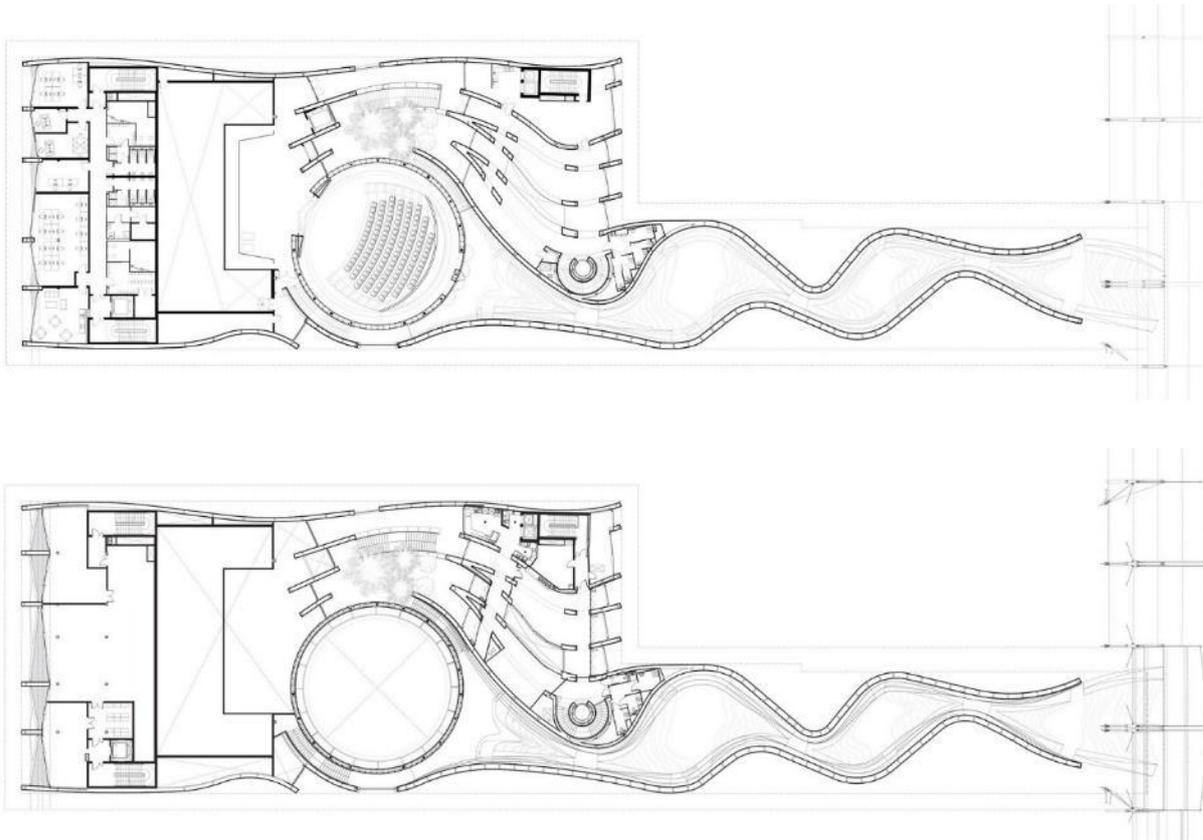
Planta do primeiro e segundo pavimentos do Pavilhão EAU | EXPO Milão 2015
